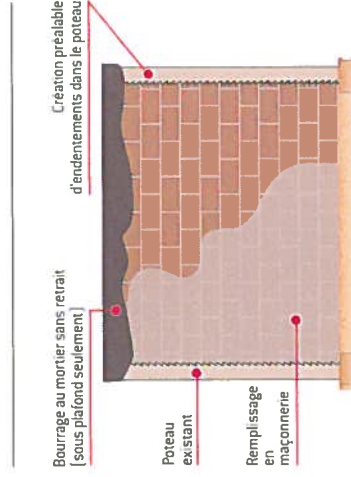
Création d'un mur en maçonnerie entre 2 poteaux existants (élévation)
